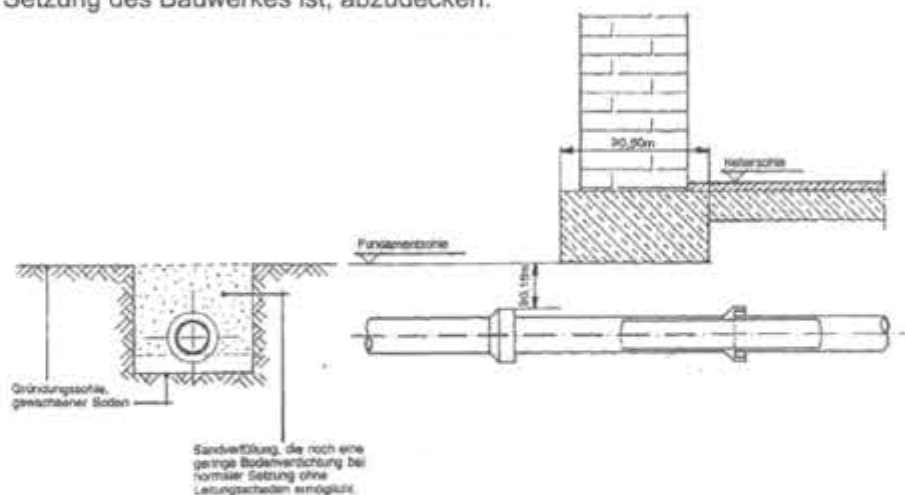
Rechtwinklige Fundamentunterquerung mit ausreichender Überdeckung
